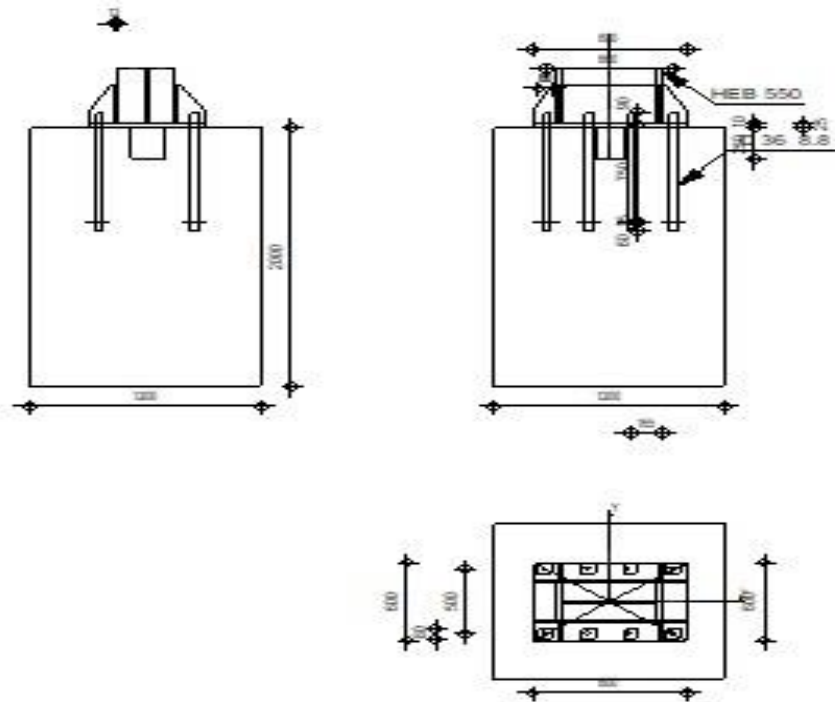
Disposition constructive de l'assemblage pied de poteau.
